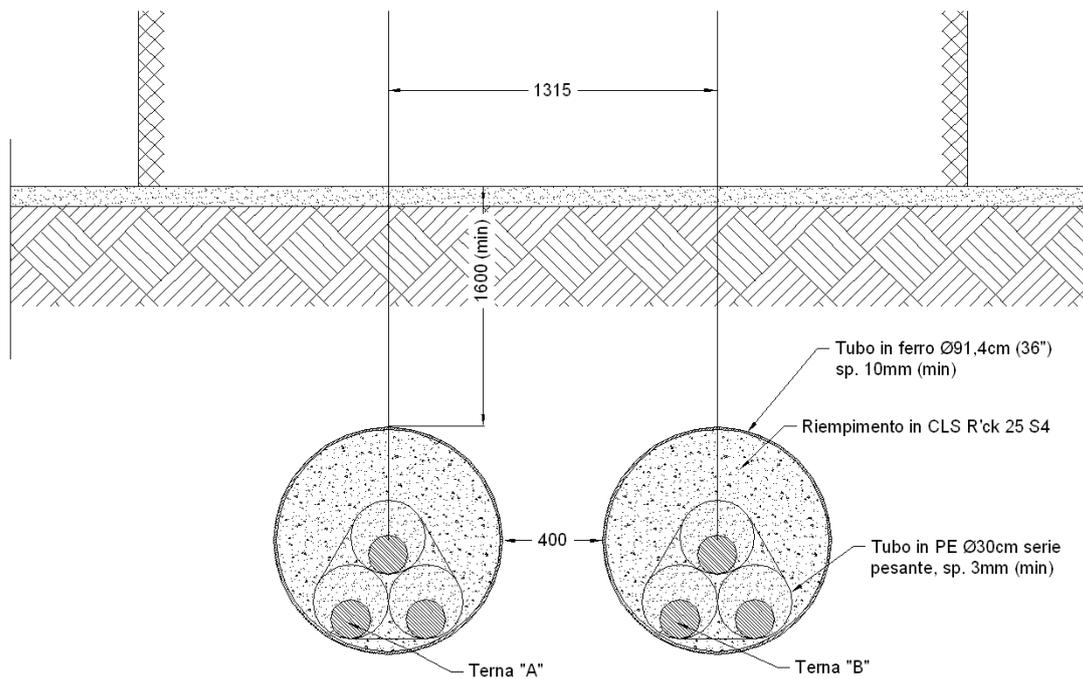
Sezione tipo "C" – Disposizione dei conduttori
